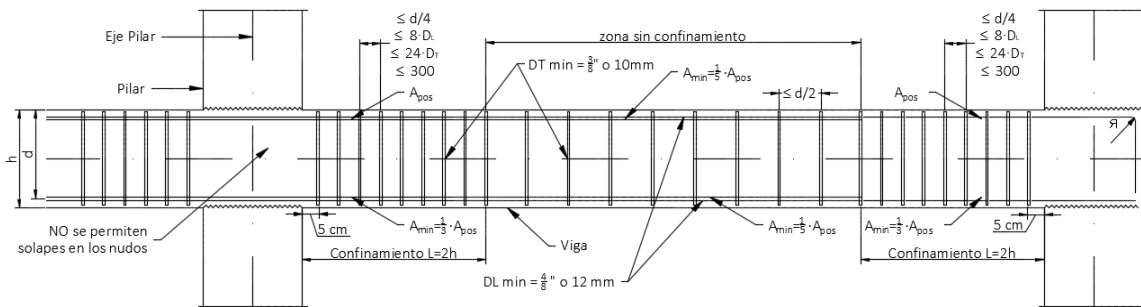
Detalle longitudinal estructural de VIGA para ductilidad DMO
